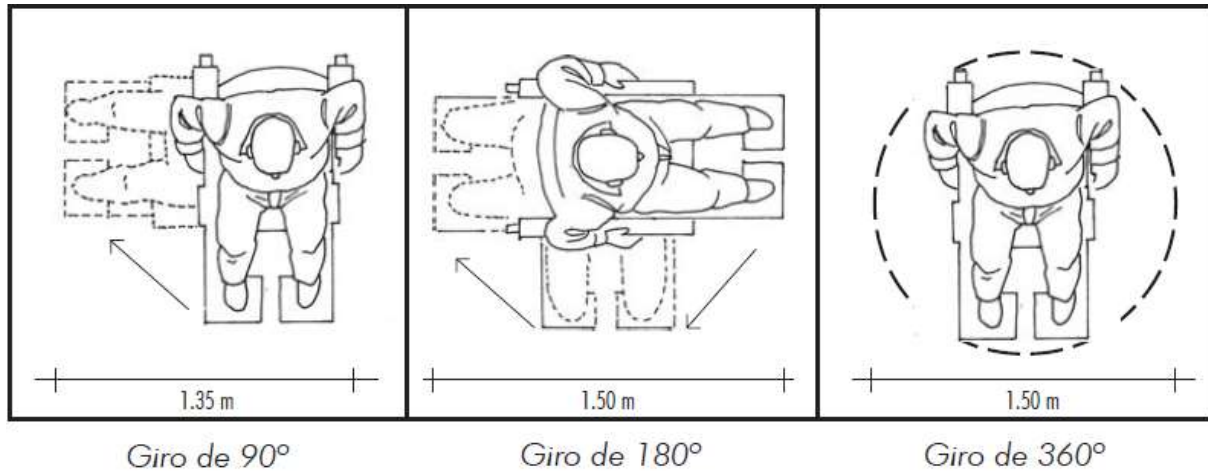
Espacio de la silla para giro de 90°, 180° y 360°
